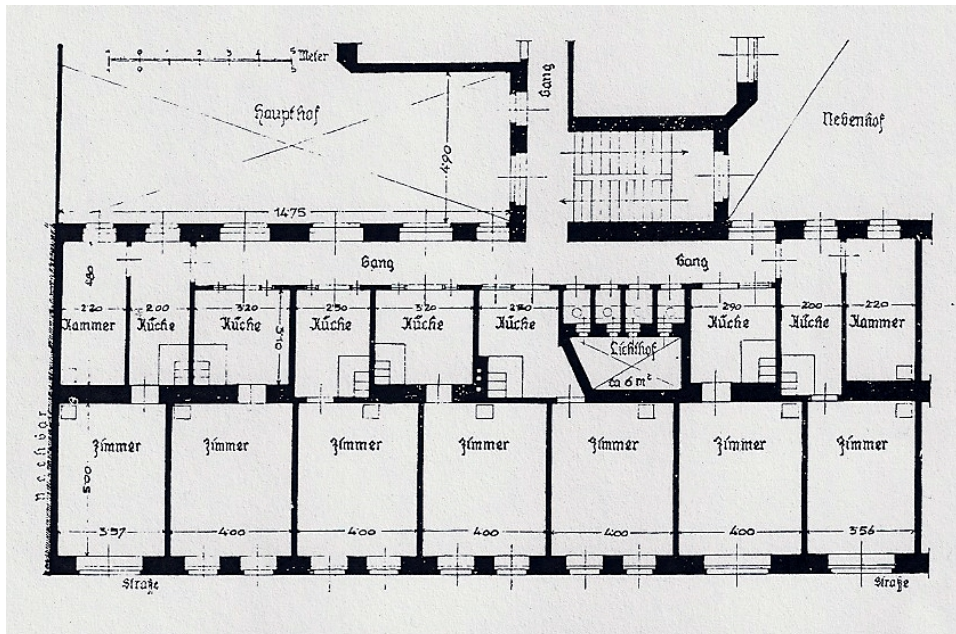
Grundriss eines Gangküchenhauses.
